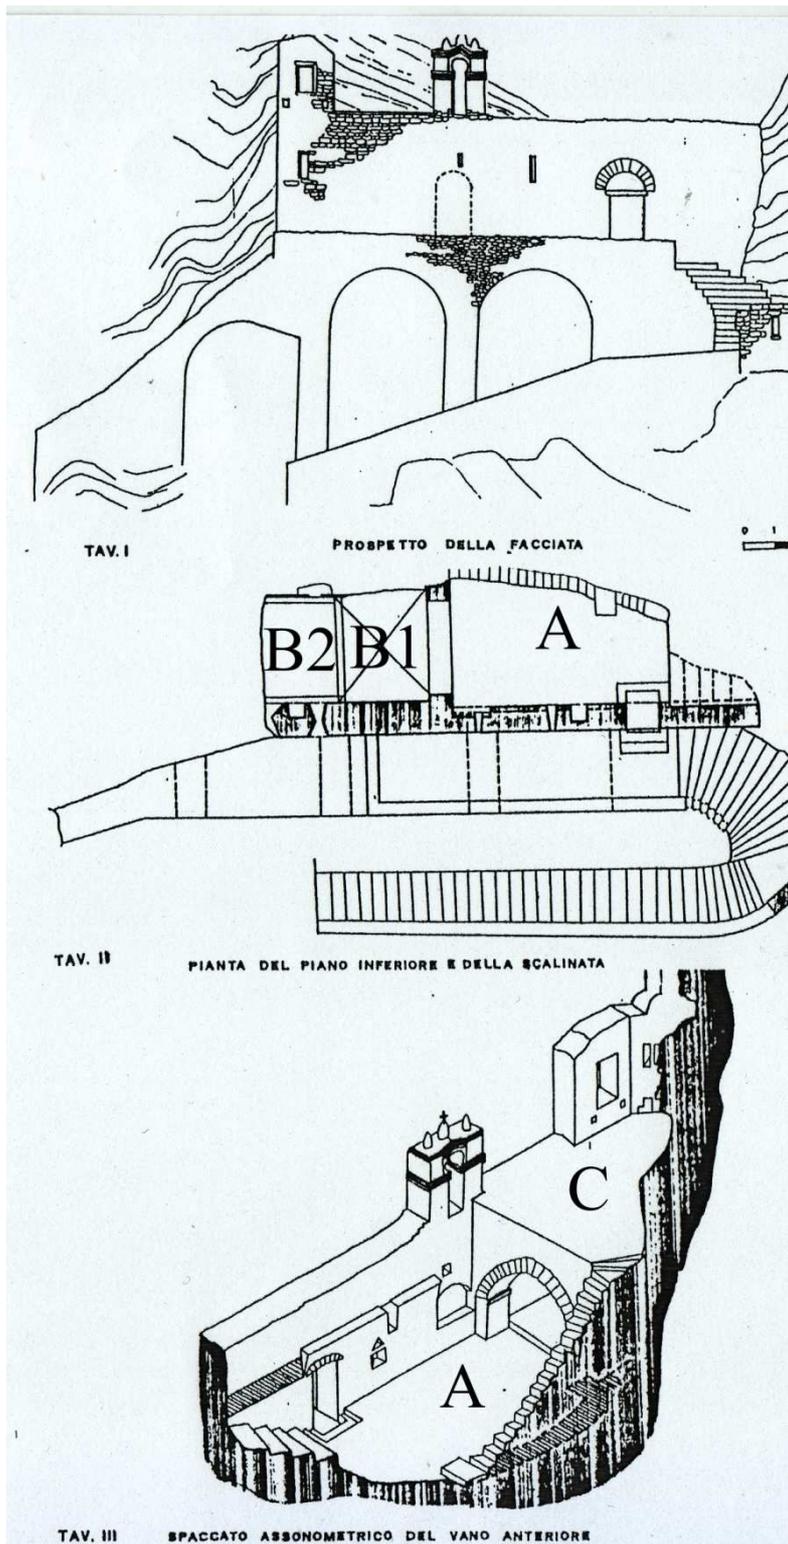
Eremito di S. Cataldo a Cottanello, prospetto, planimetria e spaccato assonometrico (fonte: Cerafogli 1988, modificato dall'autore).
